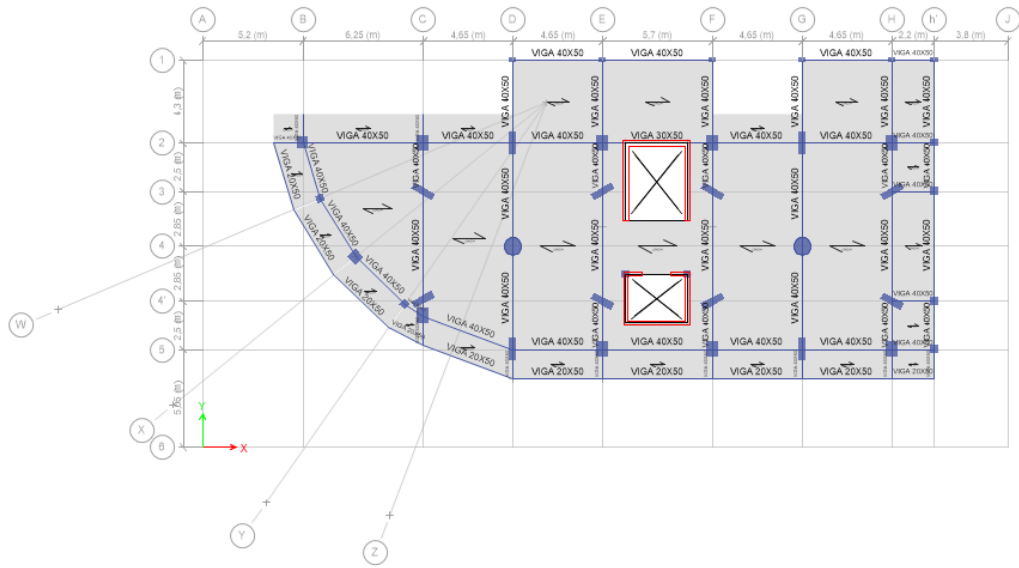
Planta nivel +4.32 m Edificio Silva Núñez
